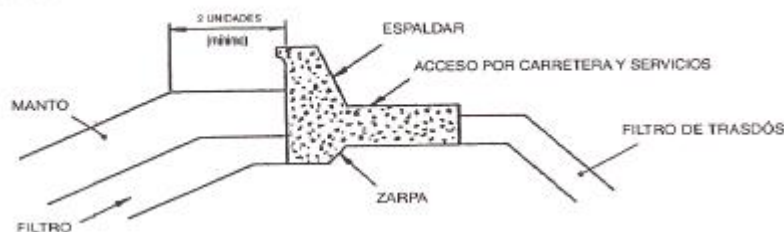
Sección tipo de la defensa longitudinal más un muro espaldón para el control del rebase.
